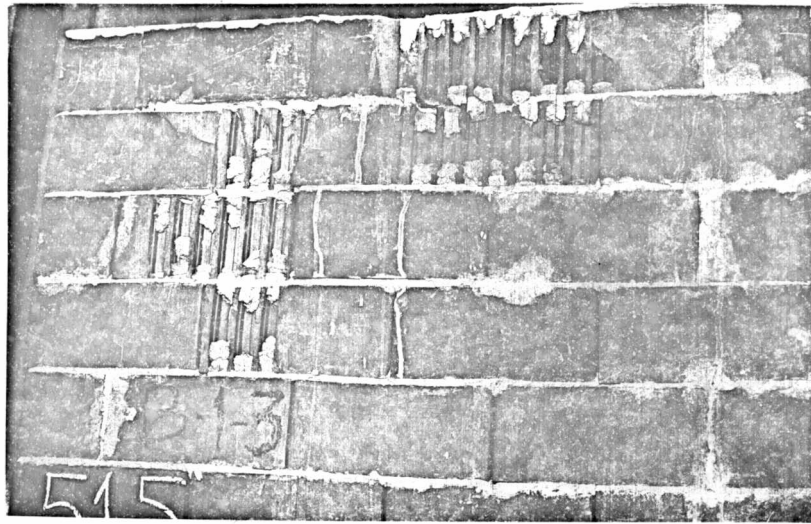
y 13.- Detalles de rotura, bloque tipo B-1
